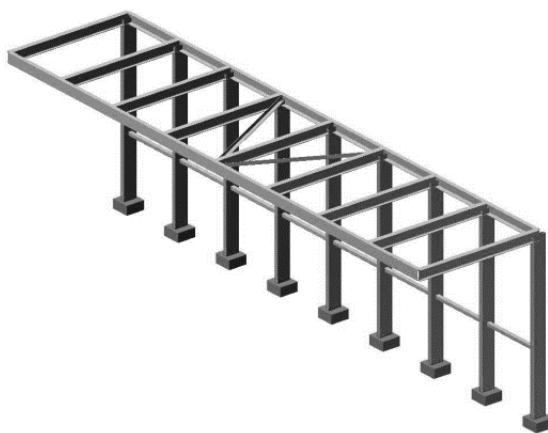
Stoffebach Perrondach - Ausschnitt aus dem Statik Modell
